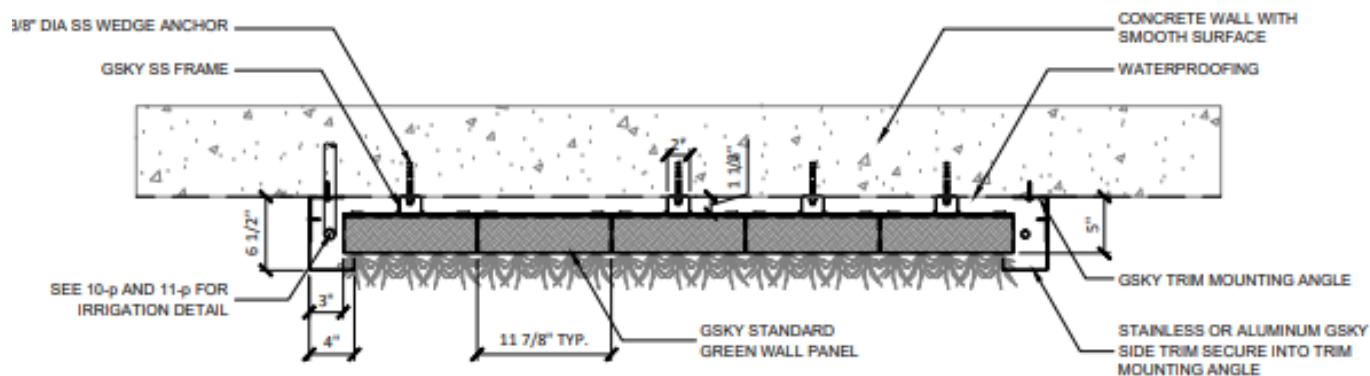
Vista en planta de l'ancoratge a la façana de l'estructura.
